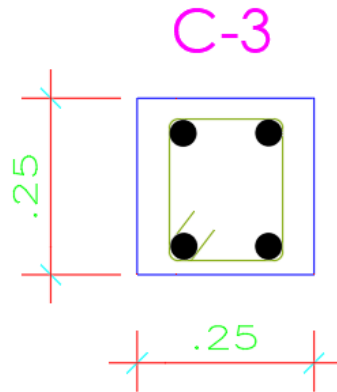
Columna C-3 rectangular sección 0.25 m x 0.25 m.
